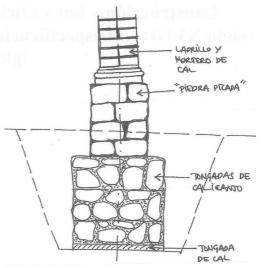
Cimentación de una pilastra de la iglesia de Albocàsser (Castellón). Pedro Gonel 1698 (dibujo de la autora 2013)
